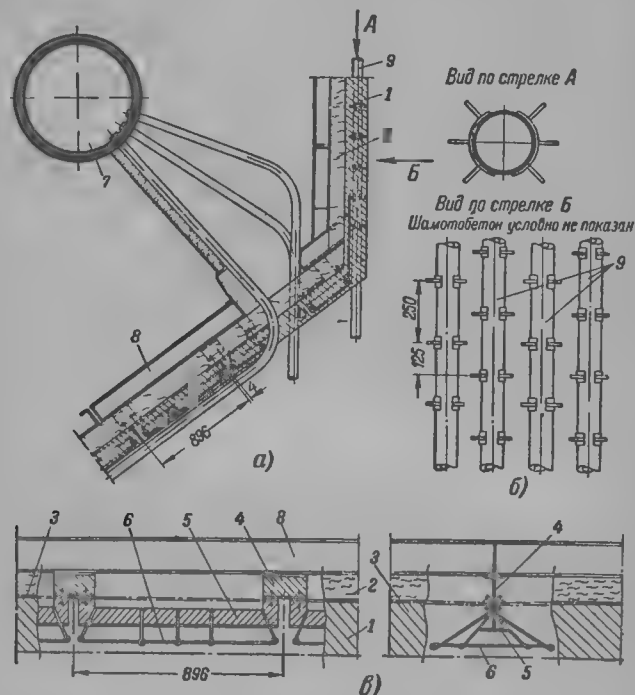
Крепление подвесного перекрытия наклонного потолка топочной камеры.
